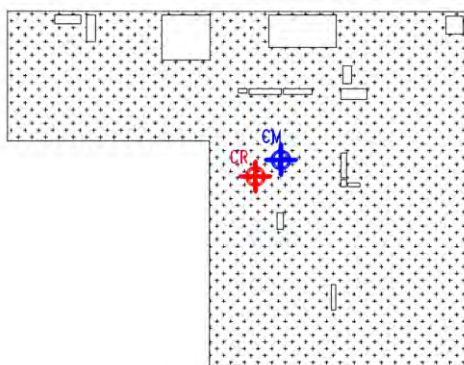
Ubicación del centro de masa y el centro de rigidez en una planta típica
